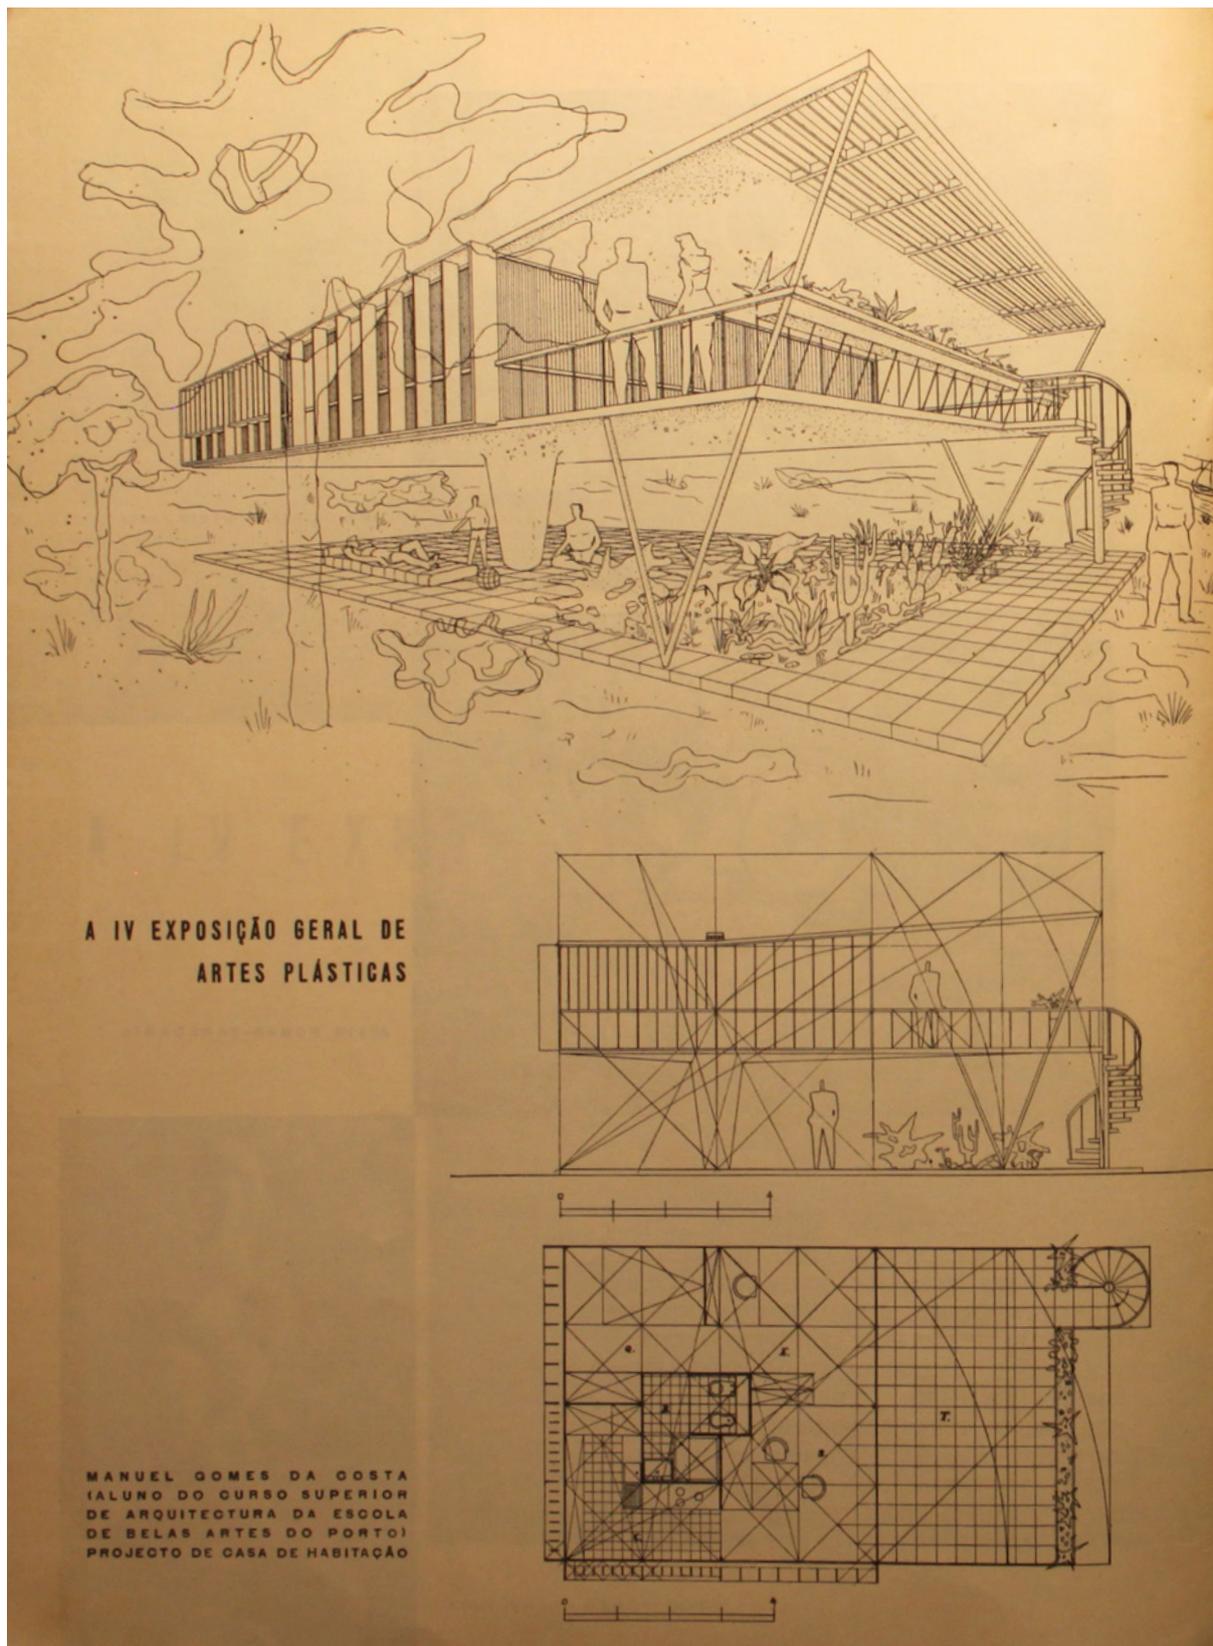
Perspectiva, Alçado lateral e Planta do projecto da "Casa de um pilar".
